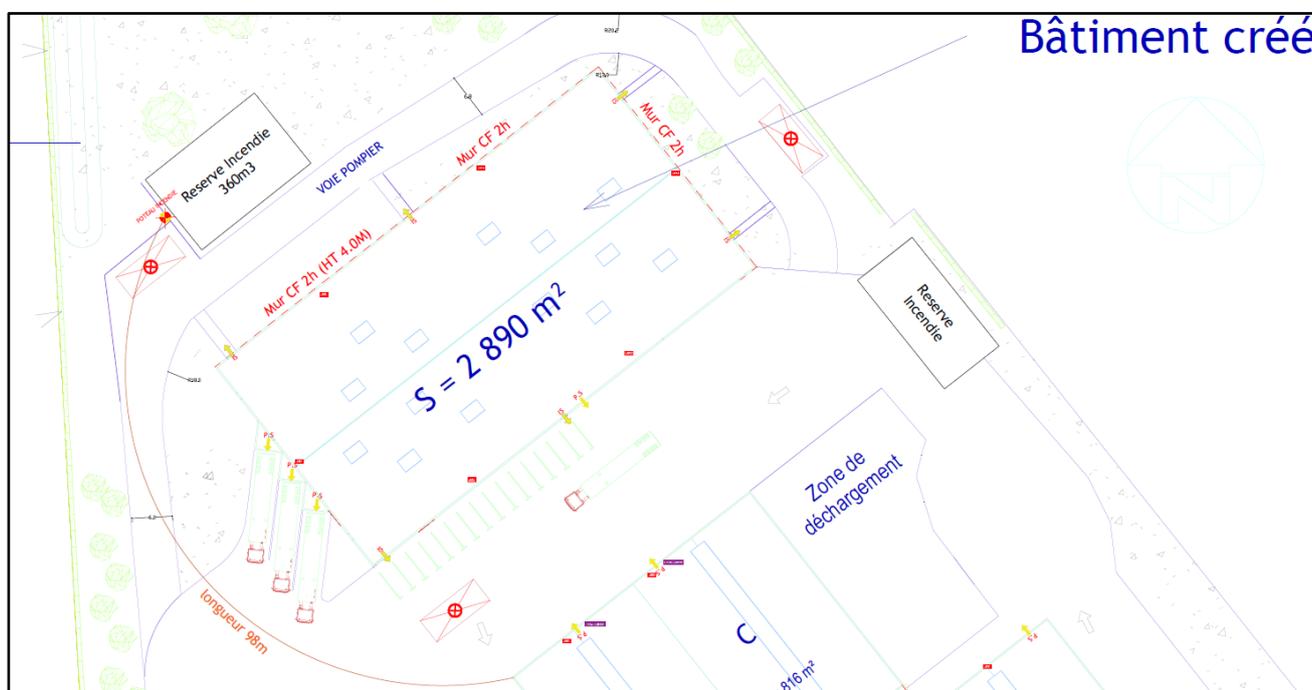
Localisation des murs coupe-feu futur bâtiment (source : sicabconstruction)
